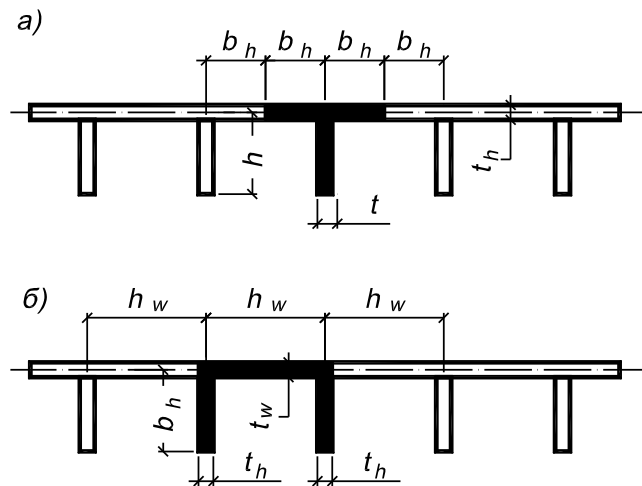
Схемы расчетных сечений пластинок ортотропных плит
